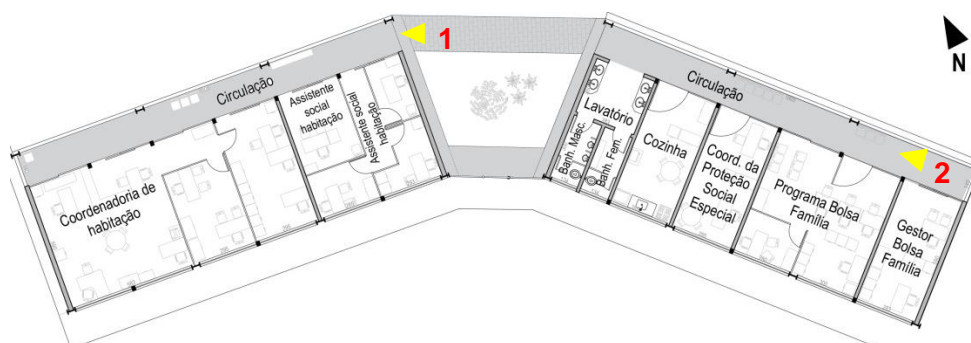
Localização das circulações dos Blocos 1 e 2 no Primeiro Pavimento.
